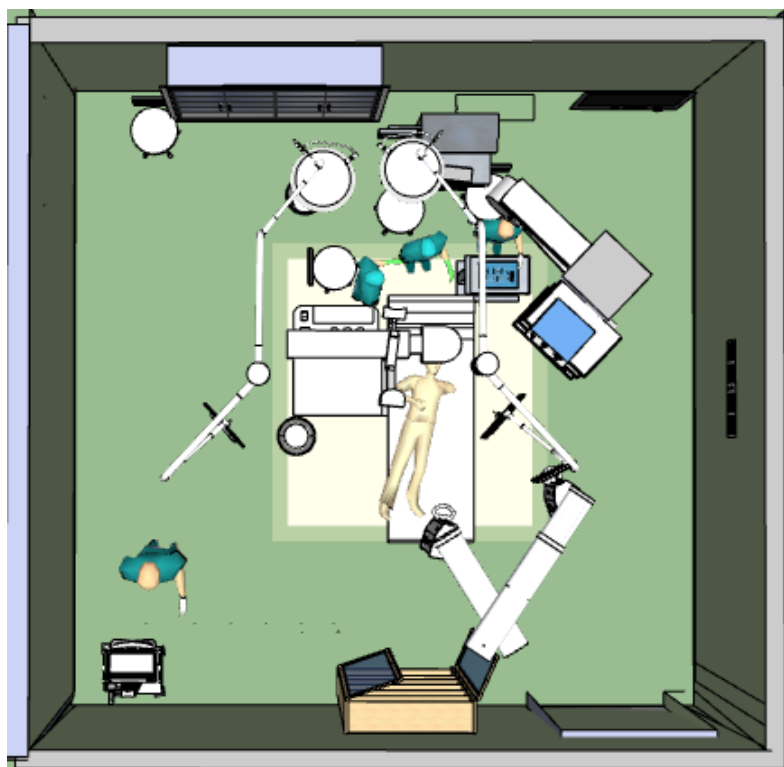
5: Planta del quirófano propuesto con técnicas de láser ([37])
